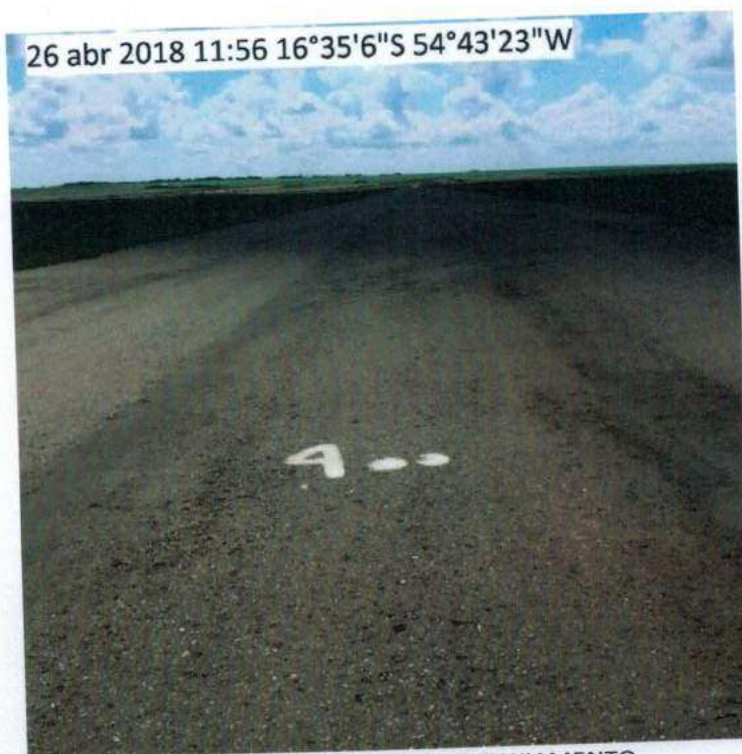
VISTA DA PISTA DE TAXIAMENTO
